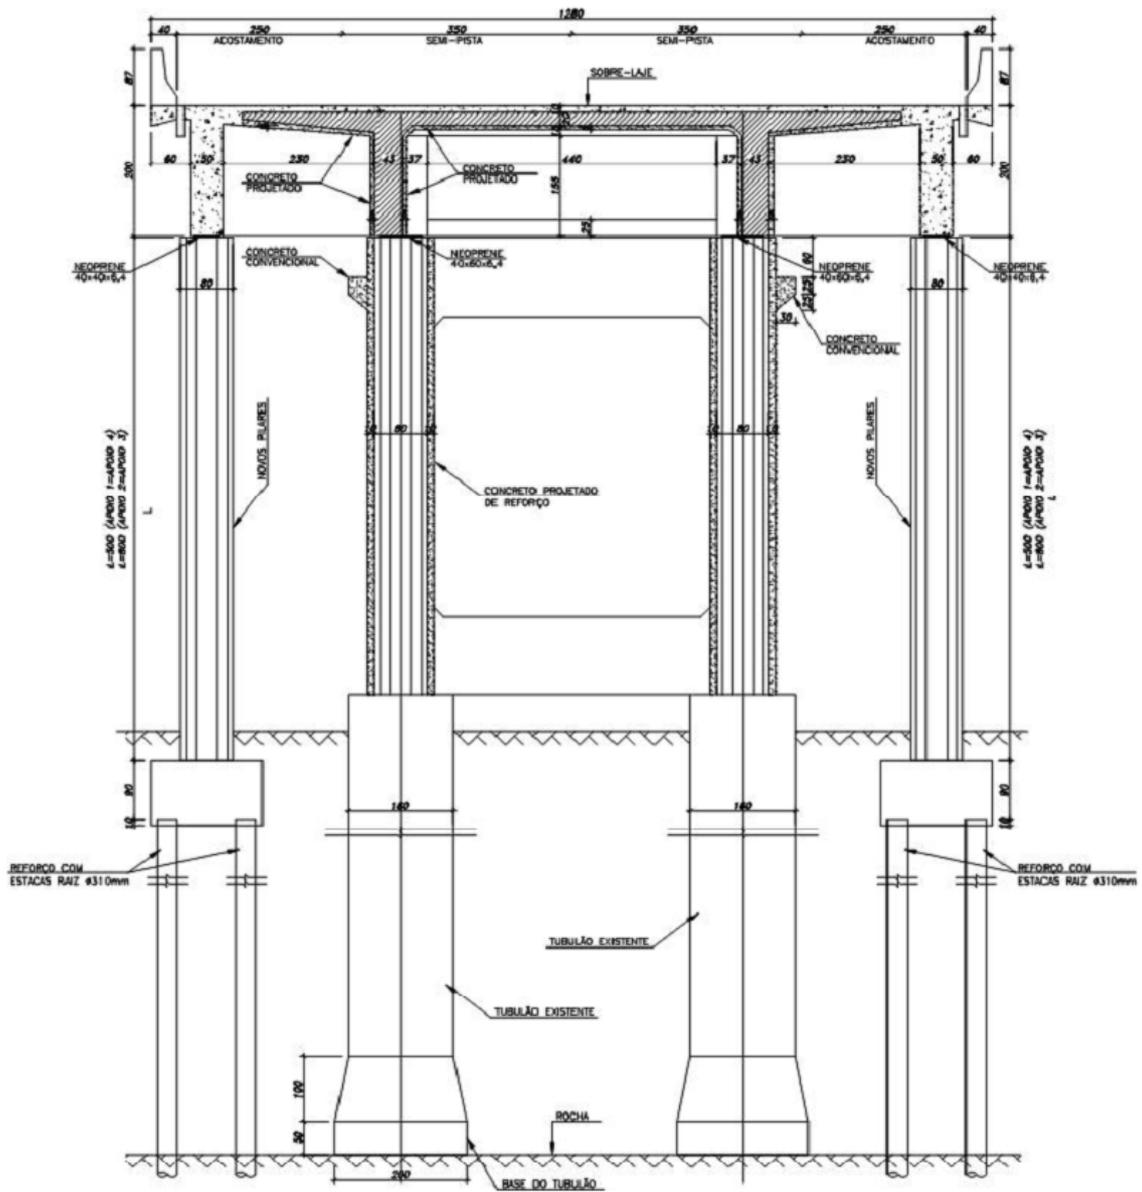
Seção transversal após alargamento, mostrando o reforço das fundações originais em tubulões com a adição de estacas raiz. (Fonte: VITÓRIO, 2013)
